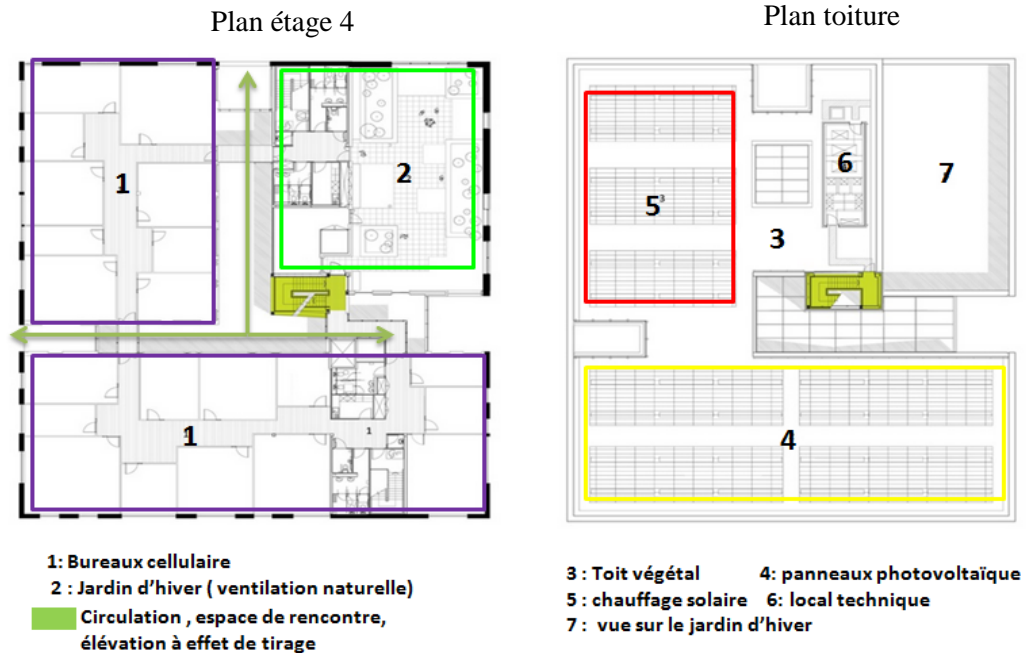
Analyse fonctionnelle plan étage 4 et plan toiture Source : Archdaily.com traité par auteur
